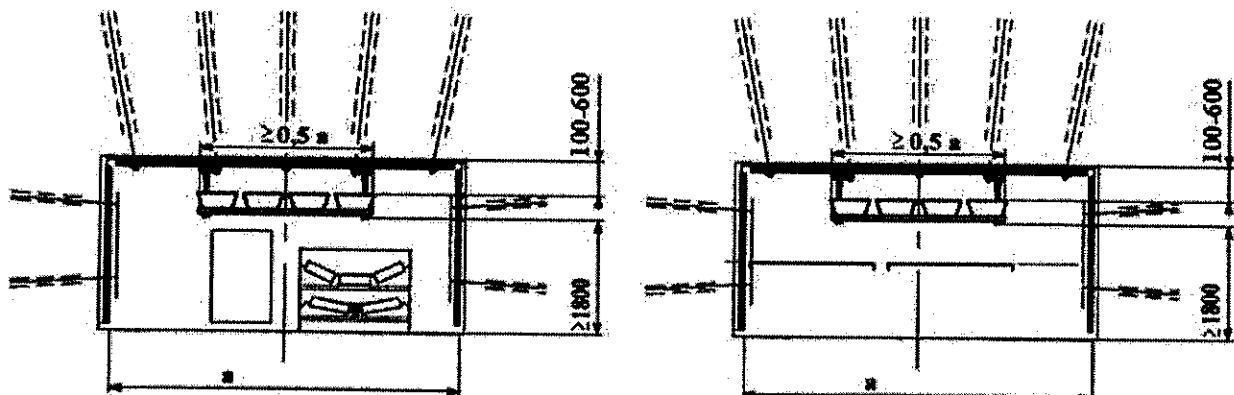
Схема установки водяных заслонов в выработках, закрепленных анкерным креплением
